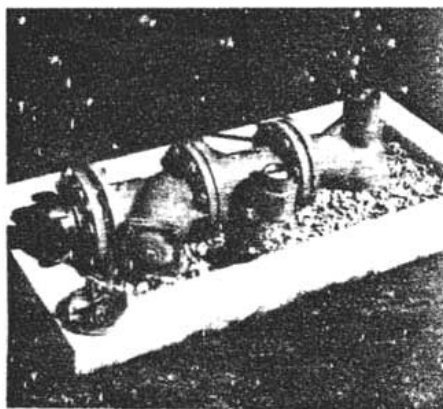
Toma de riego con contador, regulador de presión y limitador de caudal
